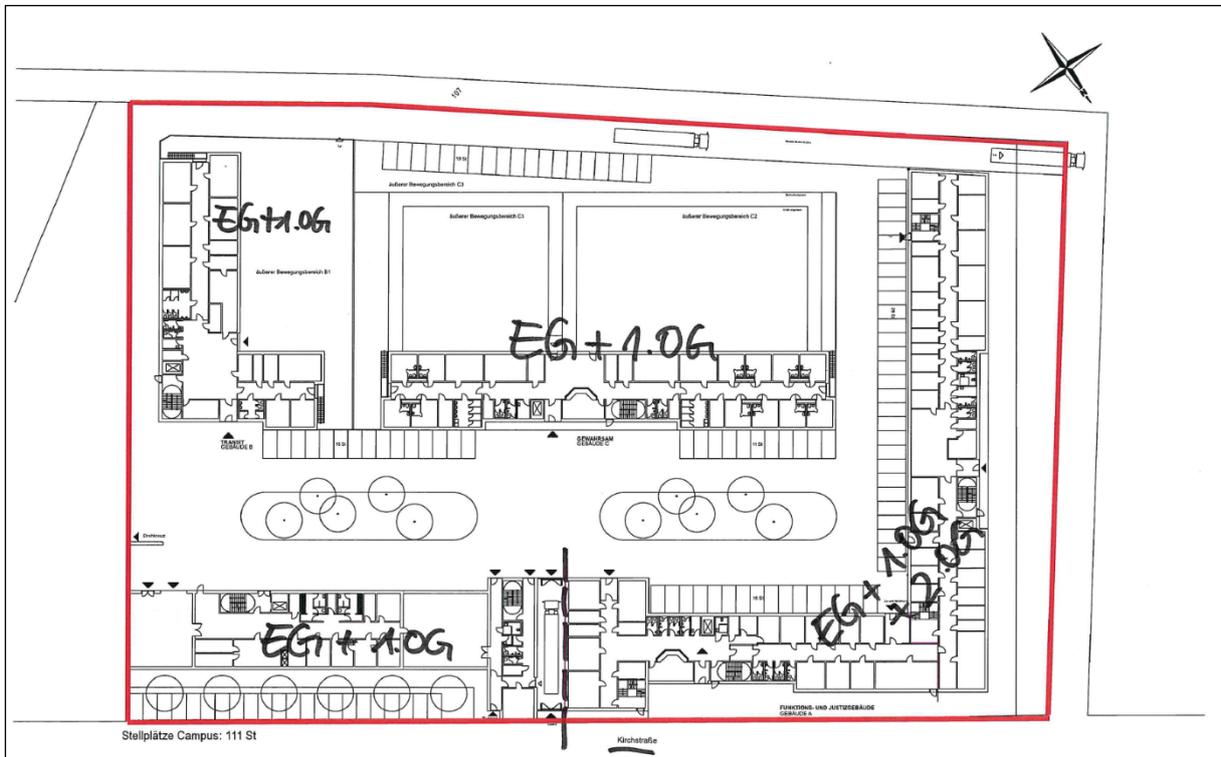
Grundriss mit Geschossangaben; Planstand: 07.06.2023 [U 2]
